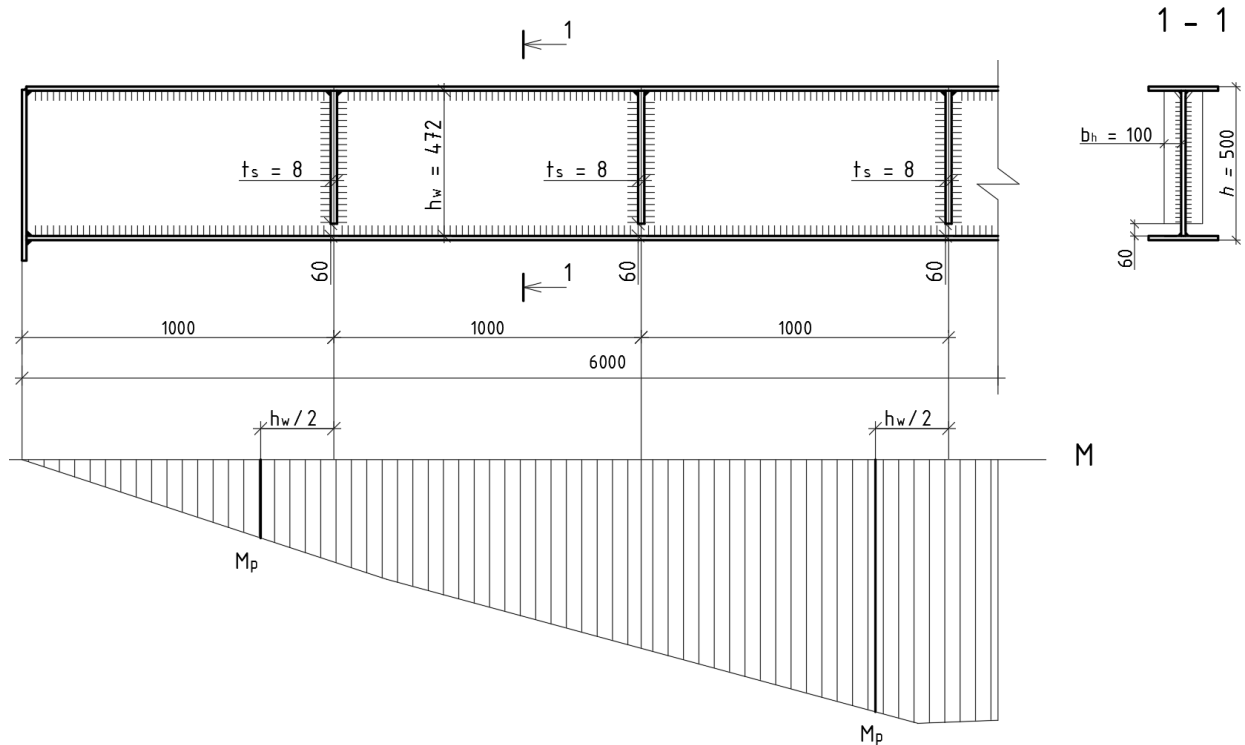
К проверке местной устойчивости стенки подкрановой балки
